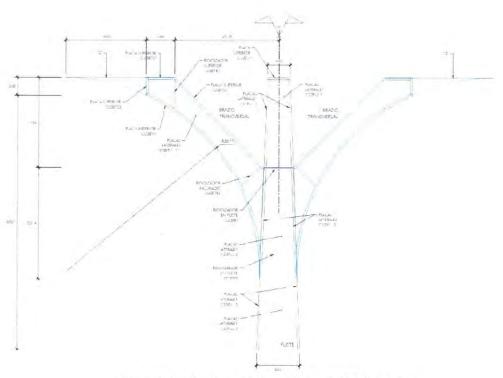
Despiece de placas de acero A50 de columna. Fuente: Planos de proyecto, 2021.
